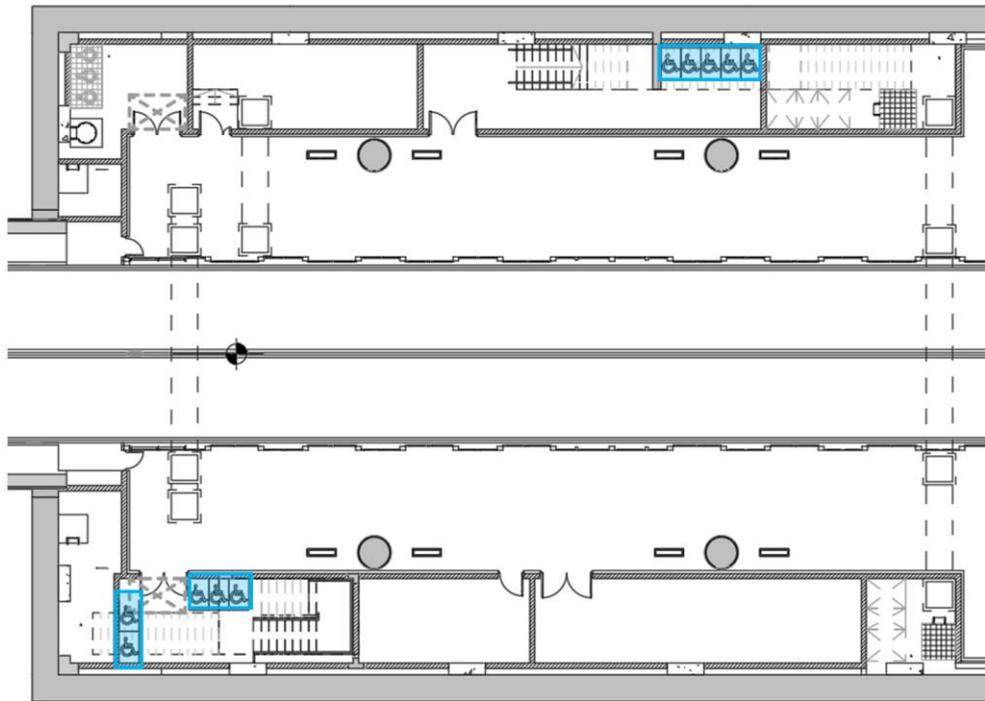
Zoom de lado oeste de planta de andén. Ubicación de PMR
